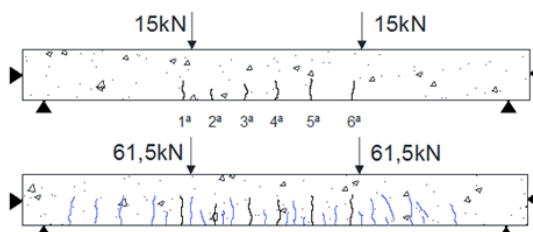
Formação e evolução das fissuras da Viga3.
